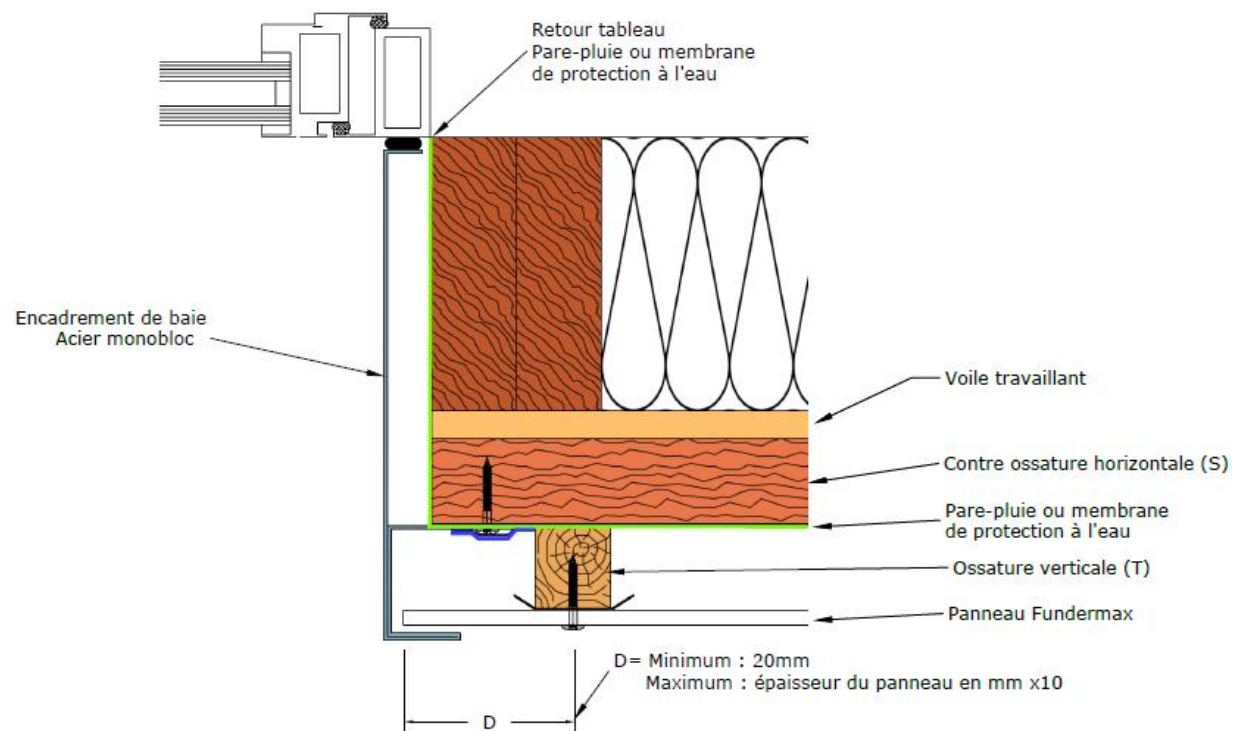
Encadrement de baie Ee2, acier 15/10<sup>e</sup> monobloc soudé 4 cotés, bardage sur FOB avec contre-ossature (S), coupe horizontale
